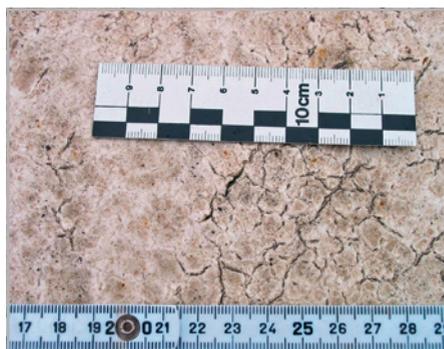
und 481: Glasbruch an einer Kunststoffdachbahn; Auslöser war der Bitumenklebeanschluss vom Nachbardach.
